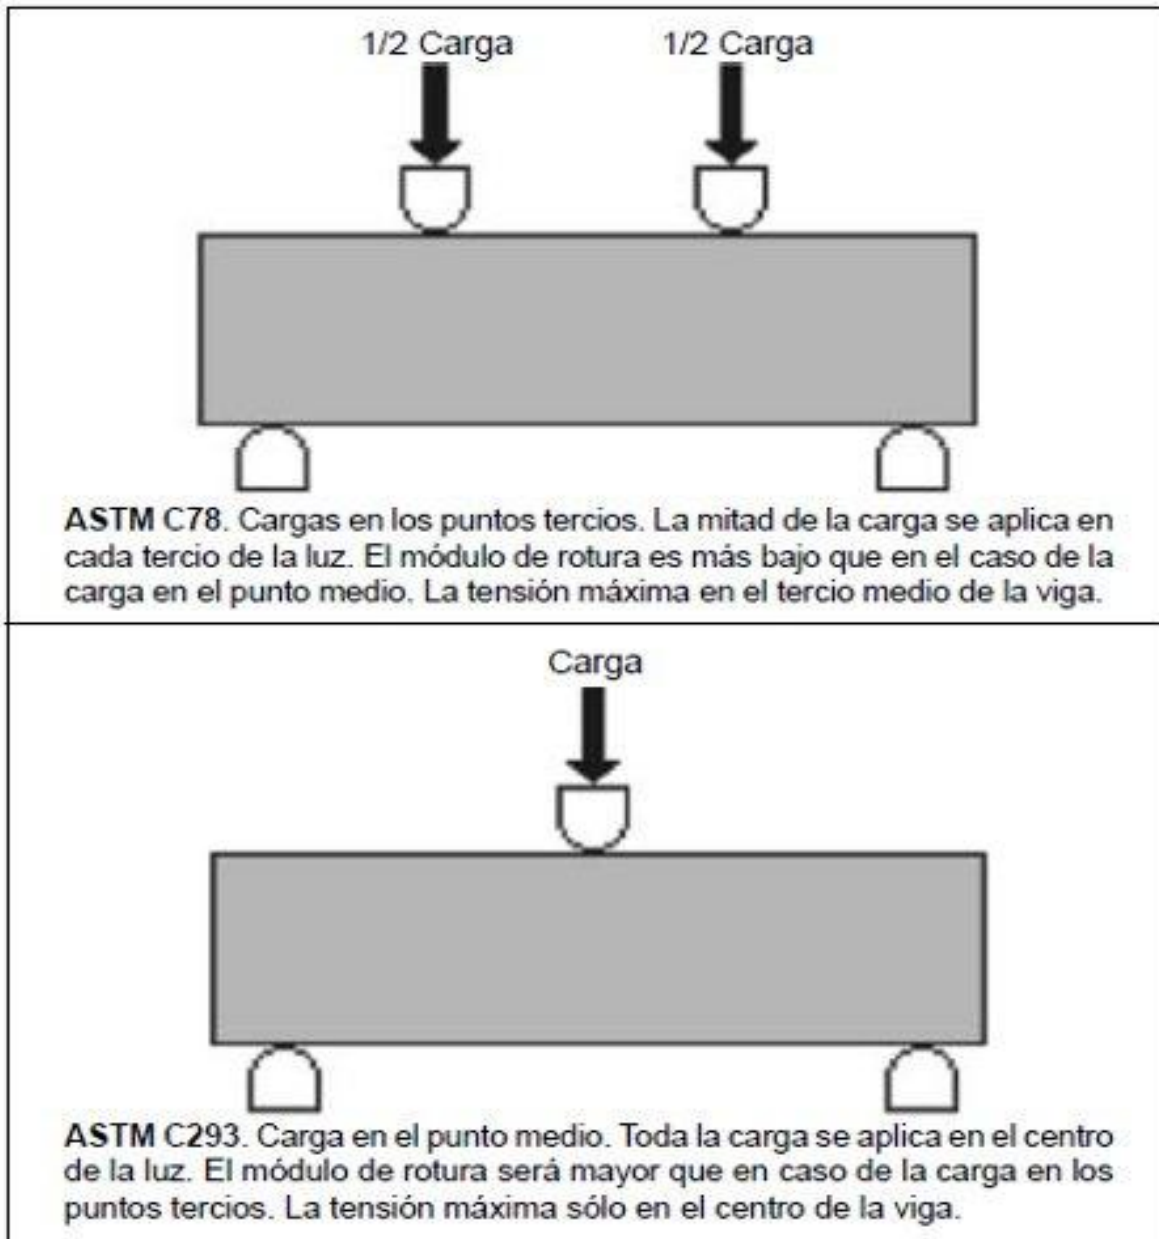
b.6 Cargas para las prueba de tensión por flexión pavimento rígido.
